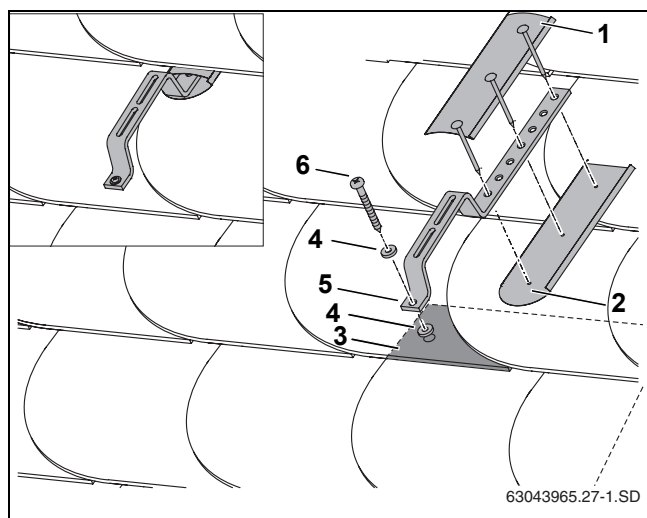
Montaje sobre cubierta de pizarra o chillas
